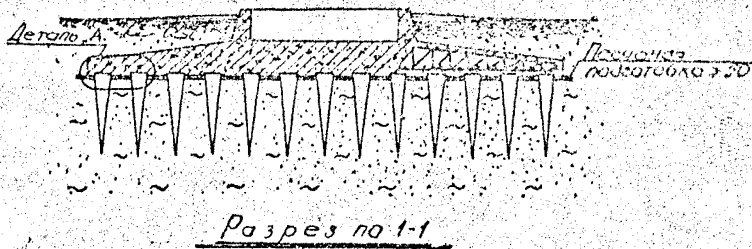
Применение пирамидальных свай в основании сплошных железобетонных плит.
